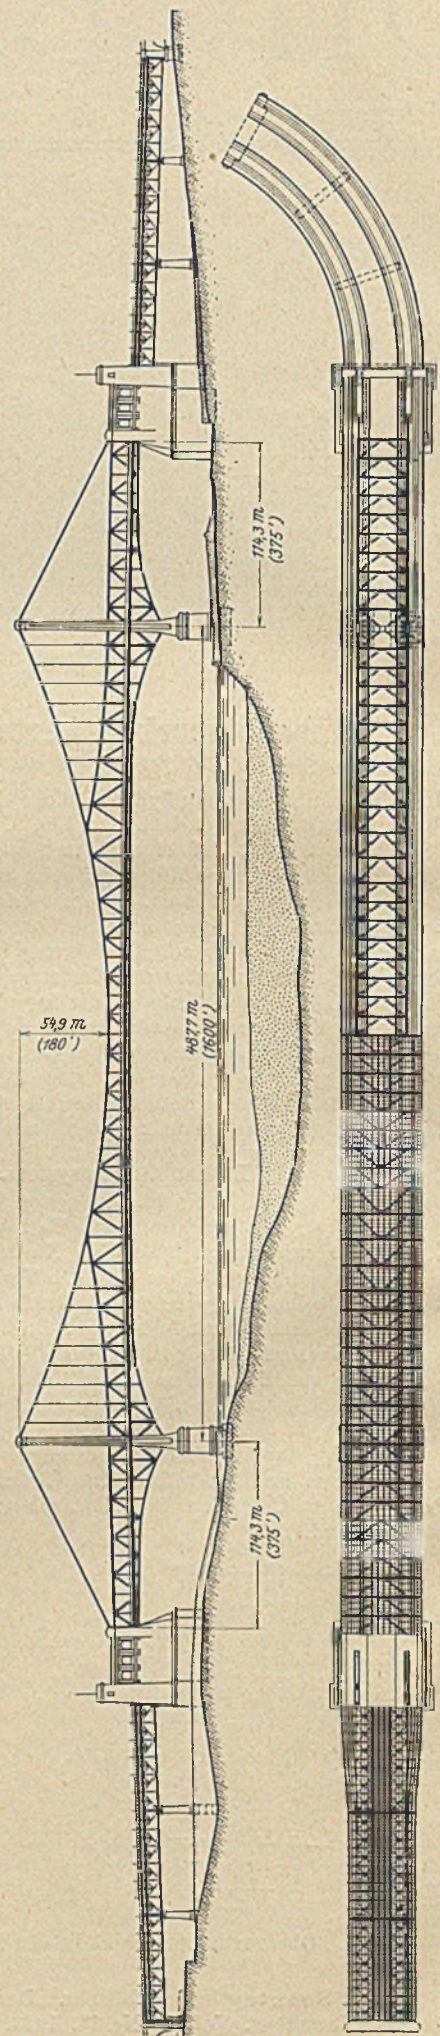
Längsansicht und Grundriß der Sydney-Brücke. Links: Fahrbahngerippe mit unterem Windverband. Rechts: Draufsicht mit oberem Windverband.
